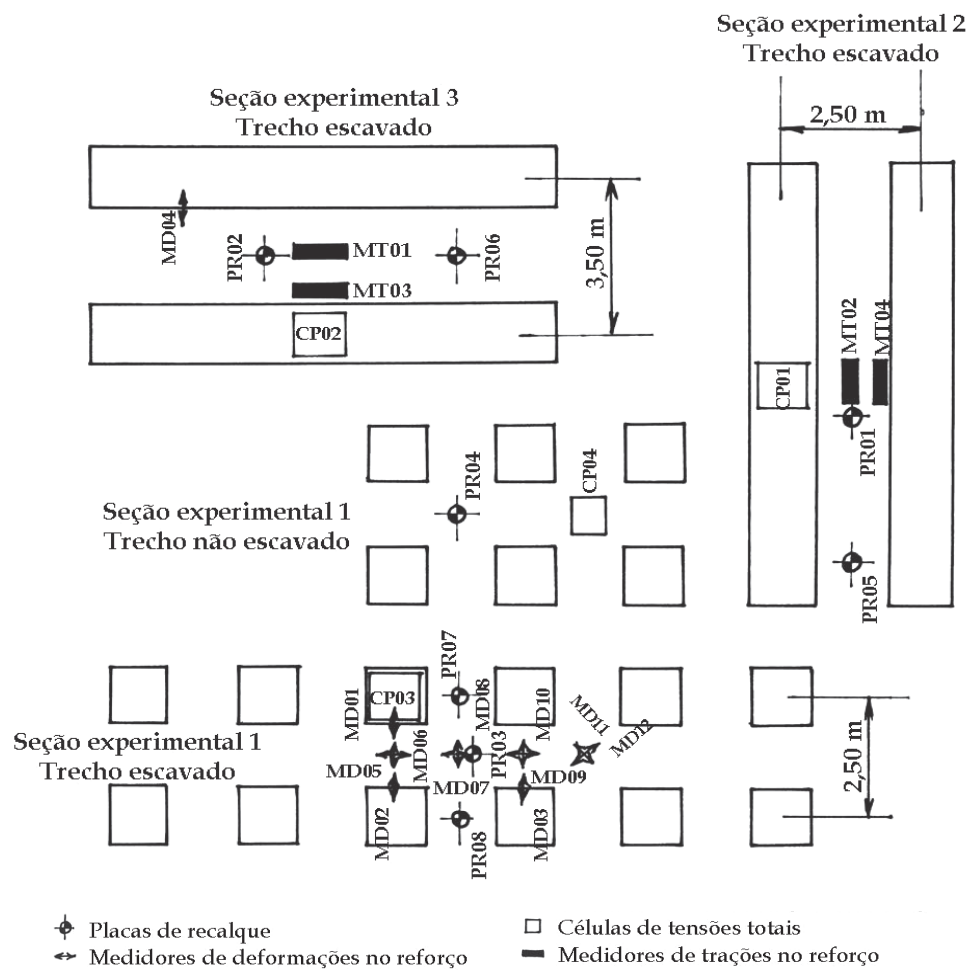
Planta baixa e esquema de instrumentação da área experimental (SPOTTI, 2006).
